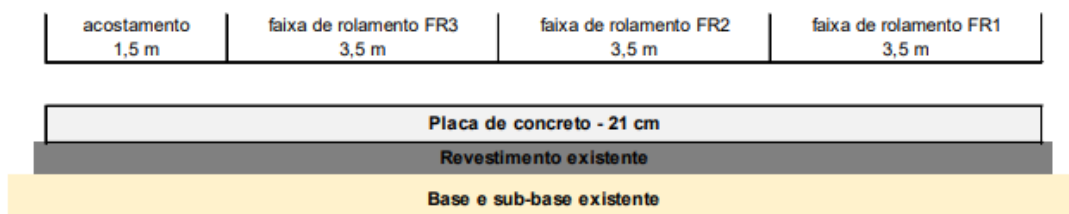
Seção tipo do pavimento rígido - *Whitotopping*.
